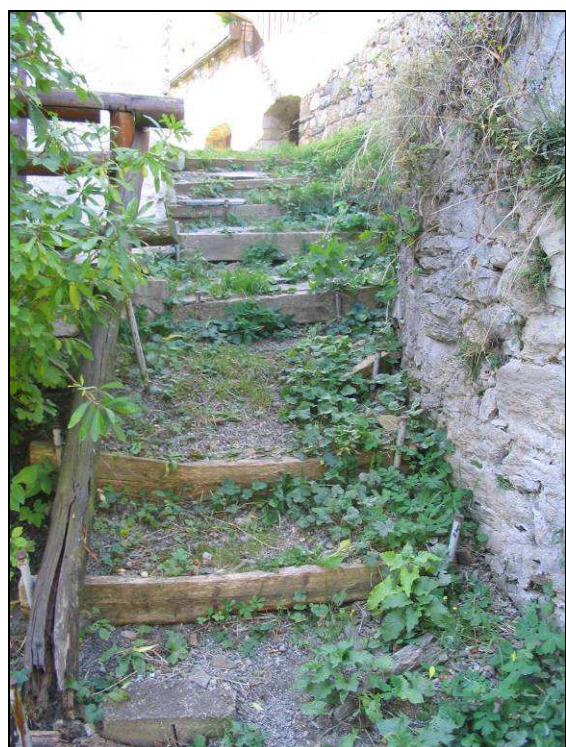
Ruelle goudronnéePhoto 7 : Escalier aménagé
